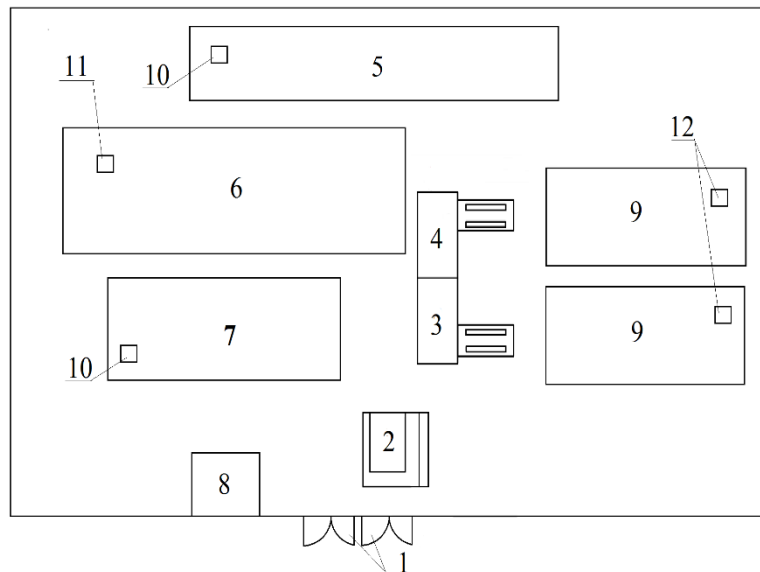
План зернокомплексу: 1 - ворота; 2 - вагова; 3 - агрегат Р8-УЗК-50; 4 - агрегат ЗАВ-20; 5 - склад фуражного зерна; 6 - ангар; 7 - склад насіння; 8 - механічна ділянка; 9 - відкриті майданчики; 10 - навантажувач ЗМ-30; 11 - навантажувач ЗМ-60; 12 - навантажувач ЗПС-100.
